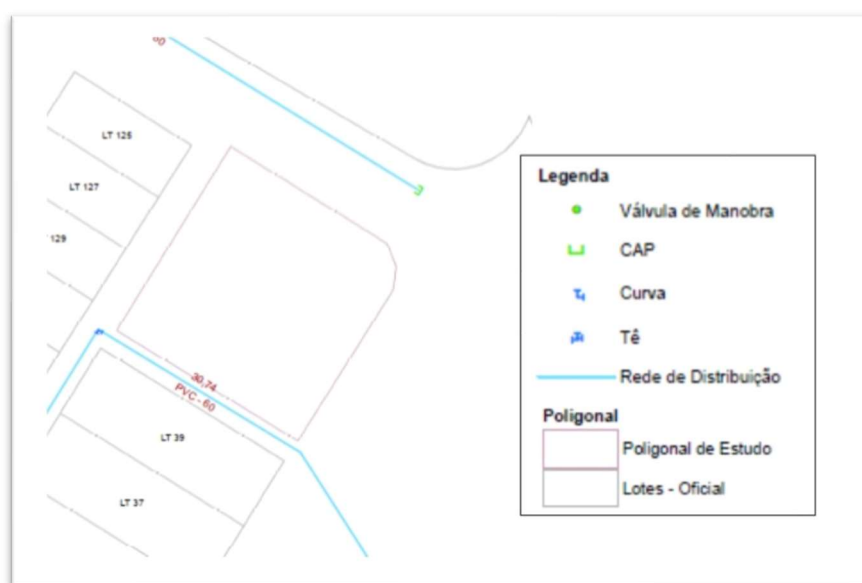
Recorte da planta apresentada na Carta n. 359/2021
